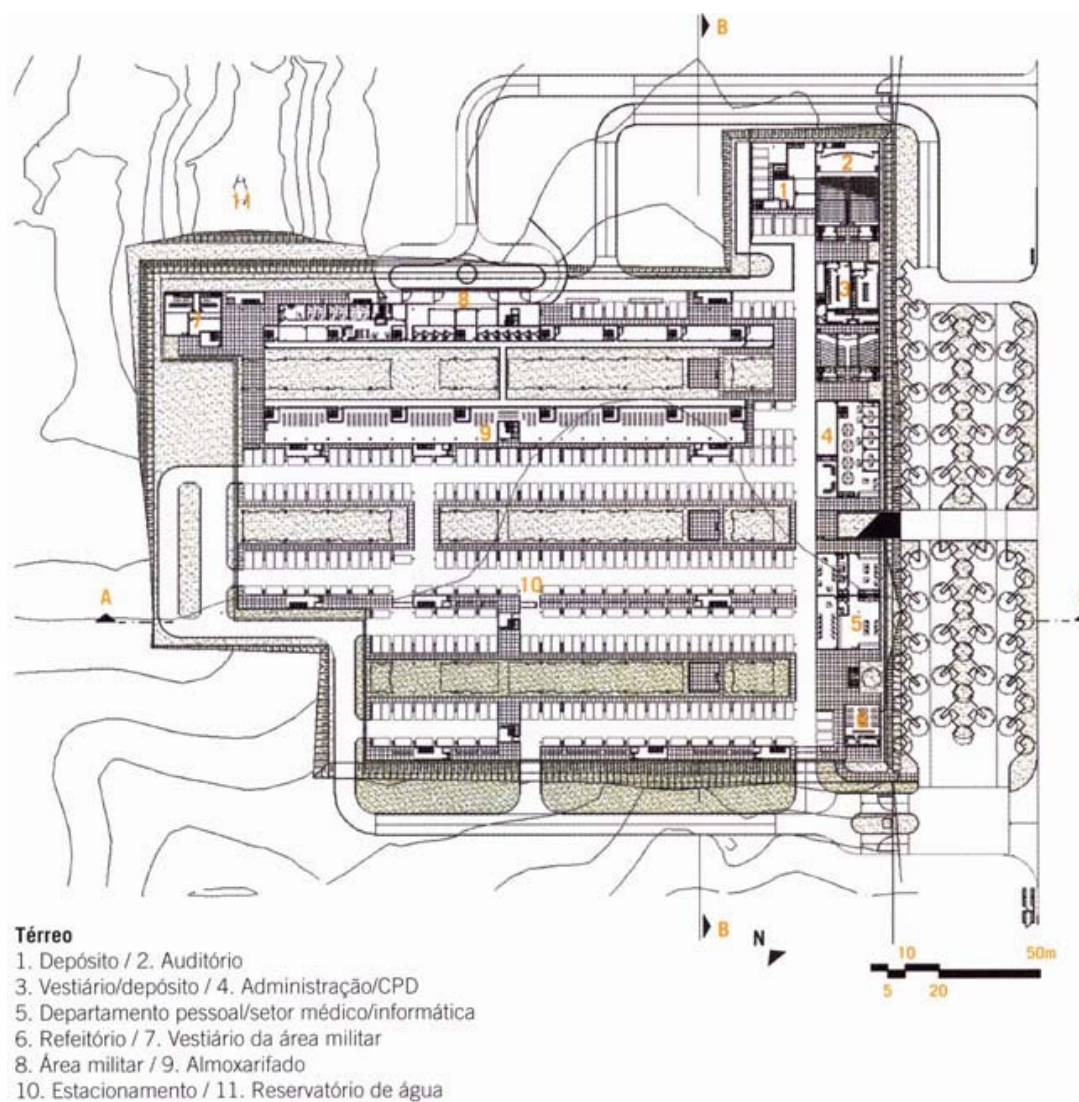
Planta do Pavimento Térreo (Fonte: Marcelo Suzuki)
